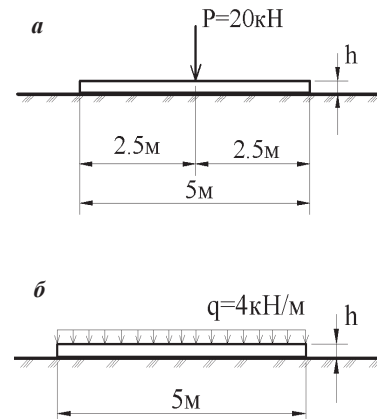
Розрахункові схеми балок на ґрунтовій основі: а) навантаження у вигляді зосередженої сили; б) рівномірно розподілене навантаження
